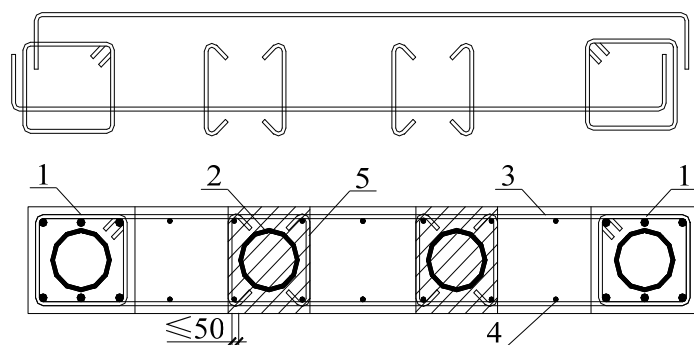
设置分布钢管的钢管混凝土剪力墙构造示意
